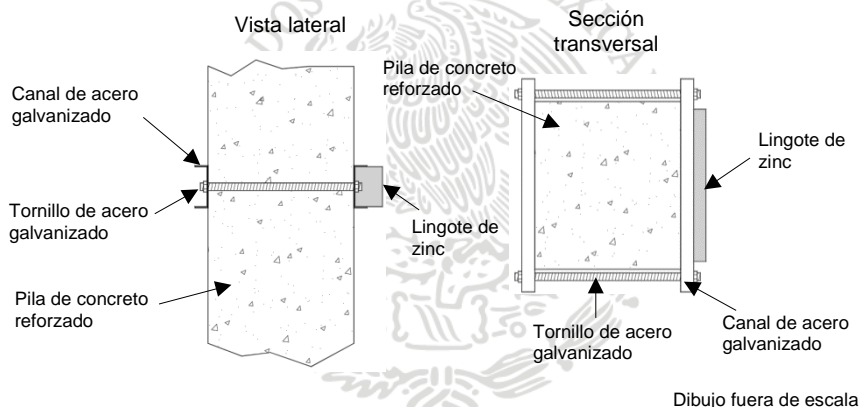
Ejemplo de un lingote de zinc instalado en una pila de concreto reforzado de sección rectangular
